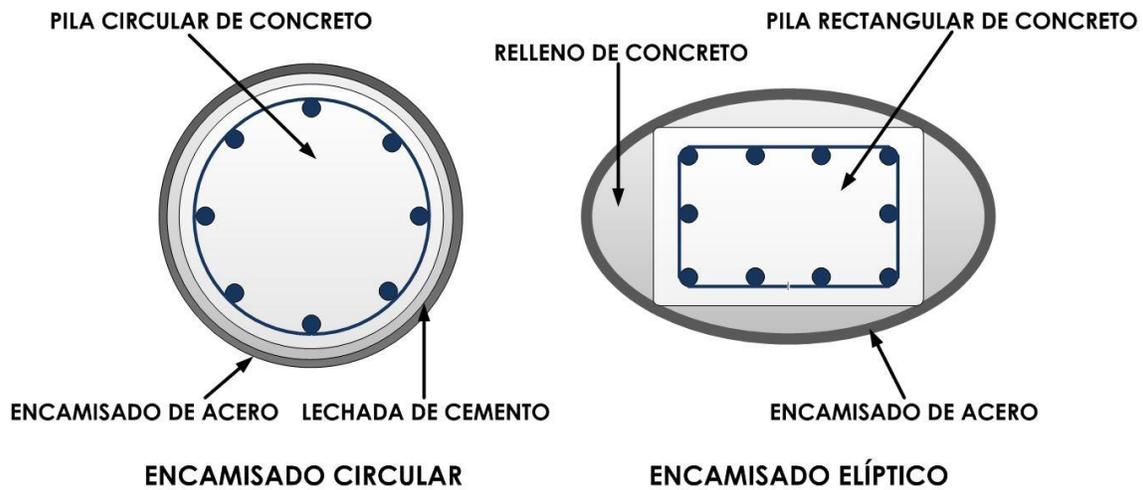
Confinamiento de una columna con encamisado de acero (Priestley et al., 1996)
